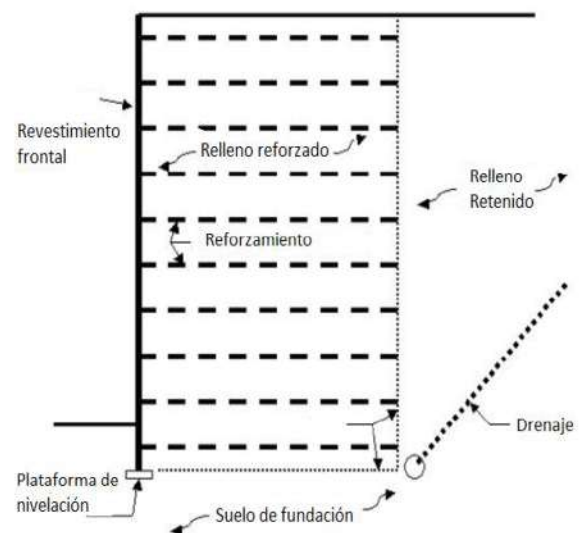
Muro de suelo reforzado (FHWA – NHI-10-024)
